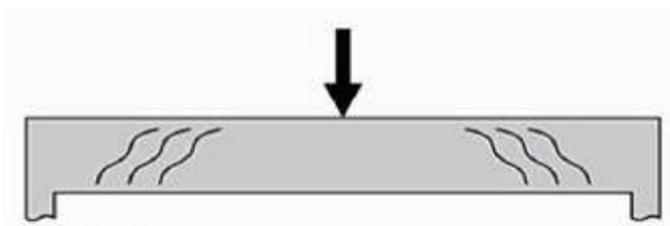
ilustração, fissuração em viga solicitada a flexão
